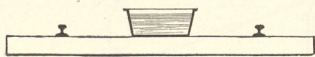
Gleisquerschnitt mit Wasserbehälter für selbsttätige Speisung.
